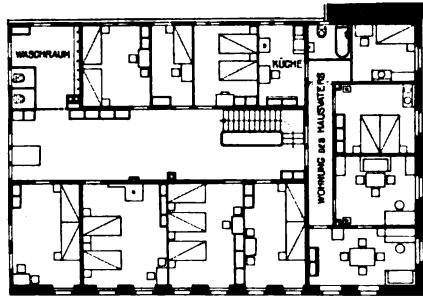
bis 14. Mittlere Mühle in Oberwinterthur, umgebaut zu einem Lehrlingsheim für Gebr. Sulzer A.-G. — Grundrisse 1:400.
